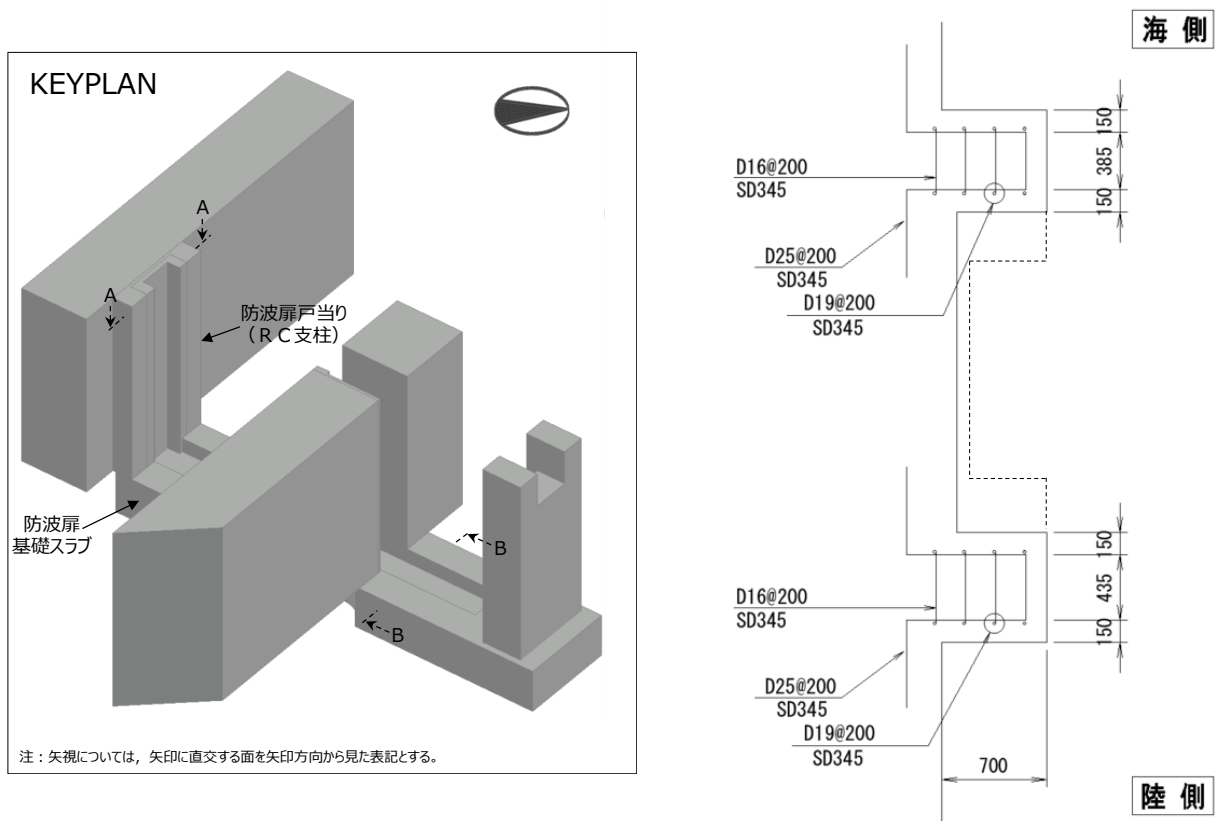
(1) 防波扉戸当り (RC支柱) の概略配筋図 (A-A 断面)
